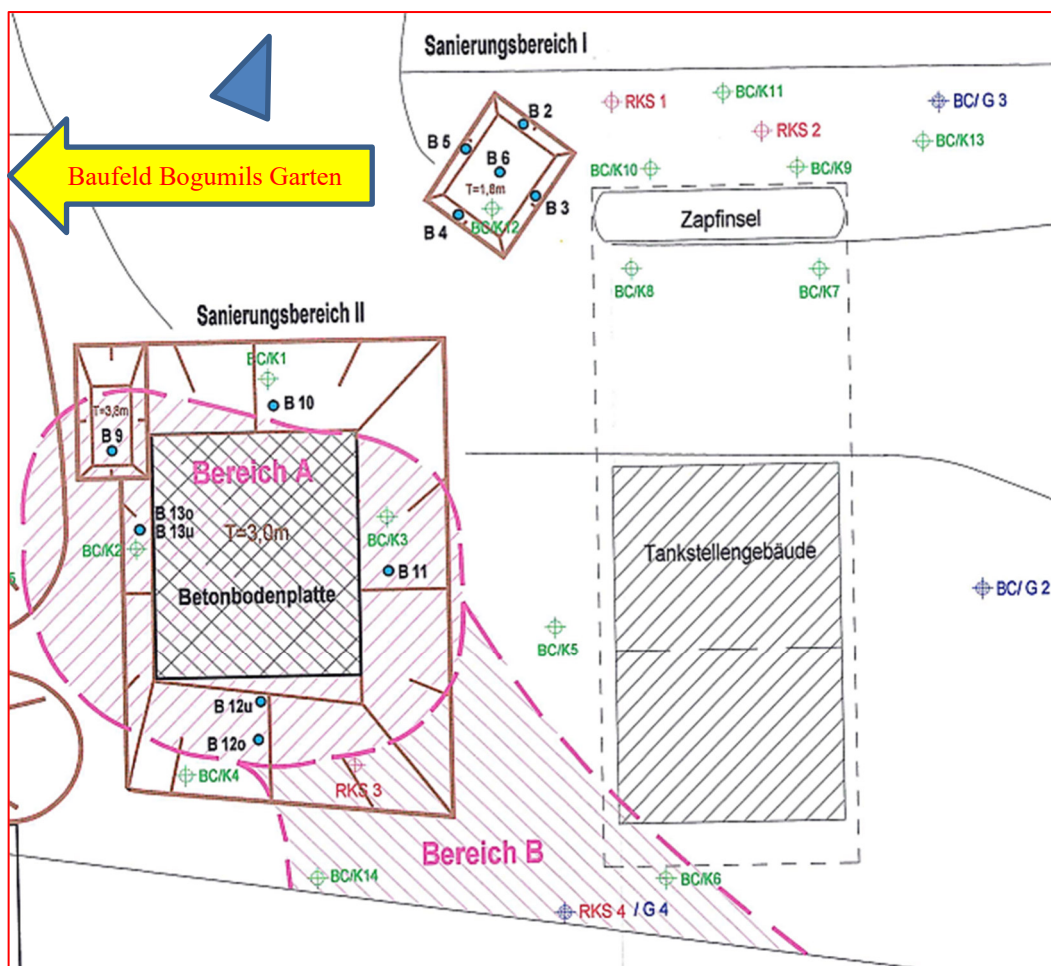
Lageplan und Ausbreitung Restbelastung
